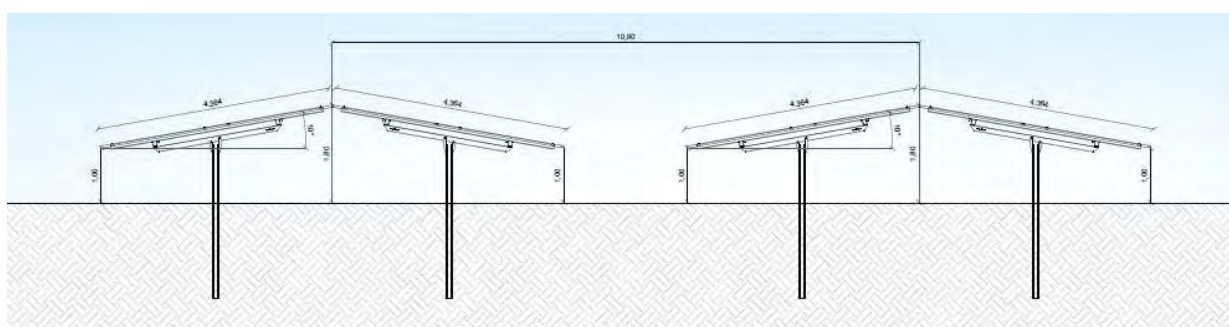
Sezione Tipo Strutture 2V (e-w)
